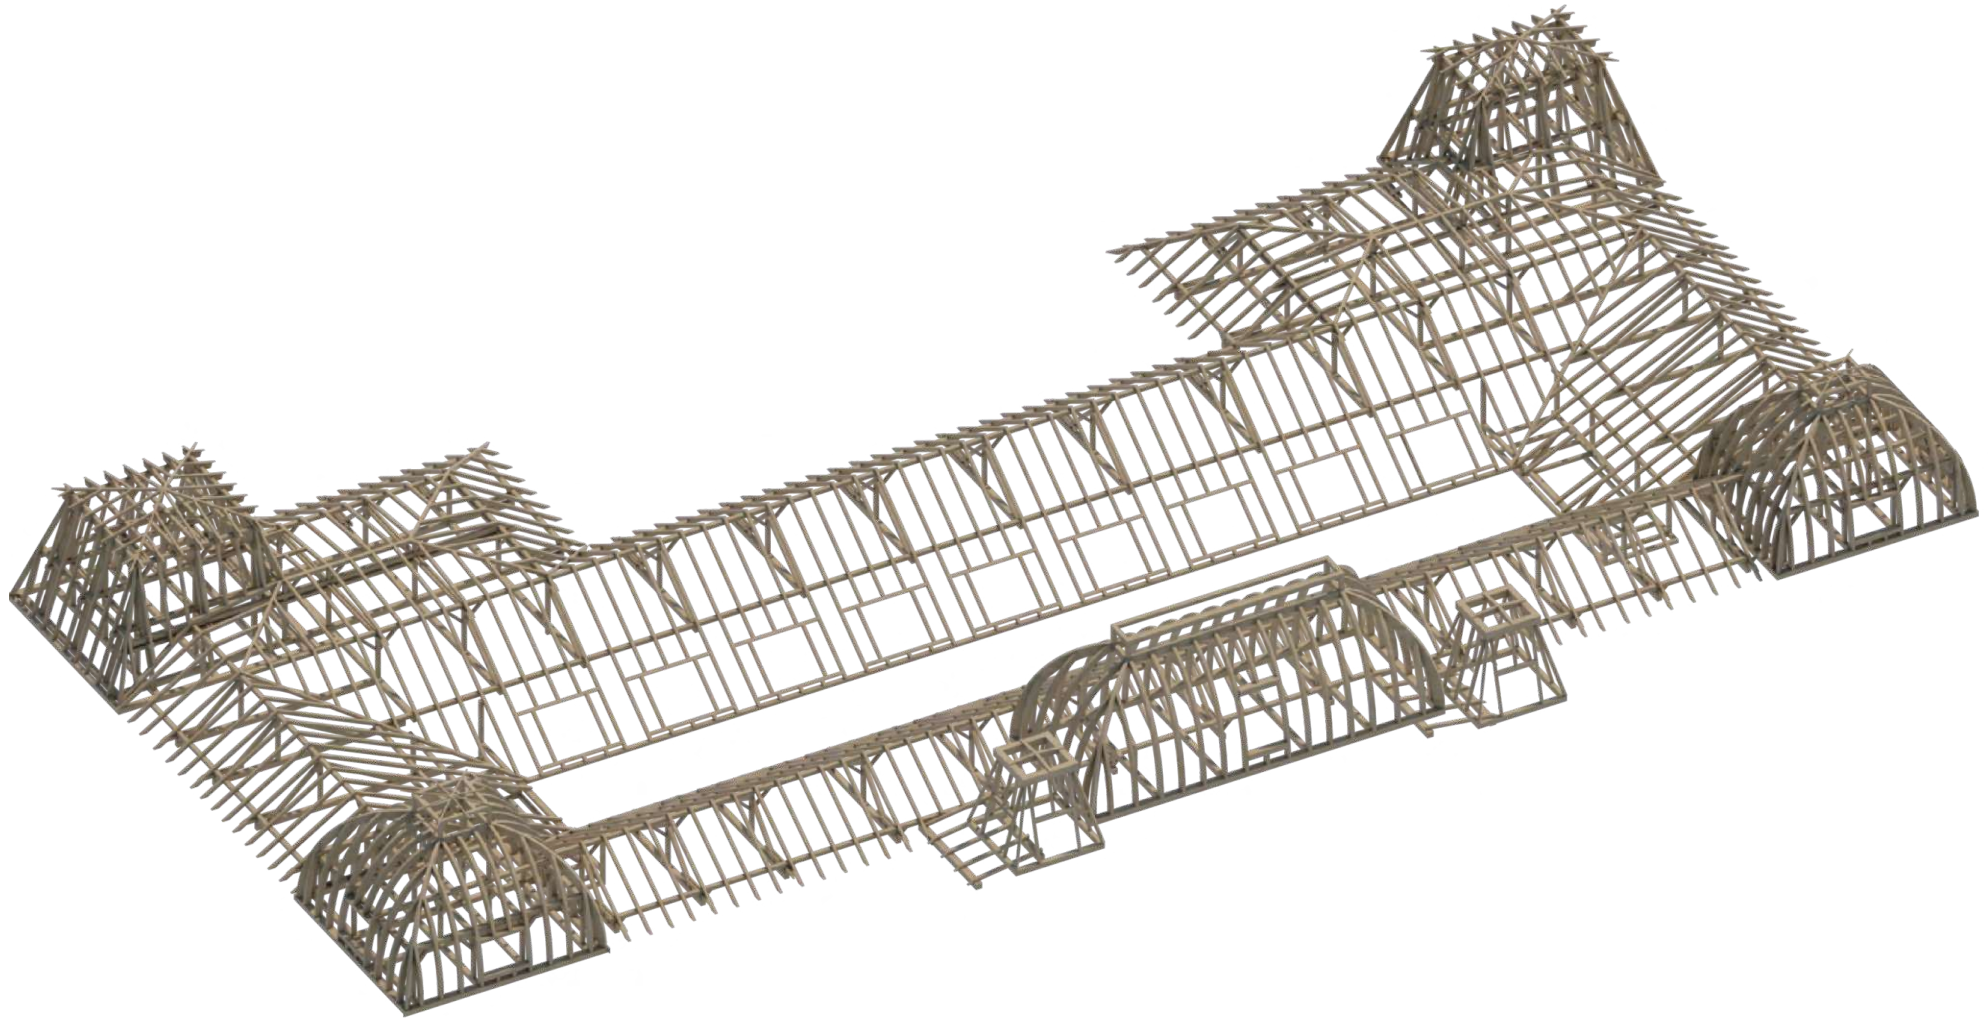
Rekonstruktionsmodell Dachstuhlkonstruktion
